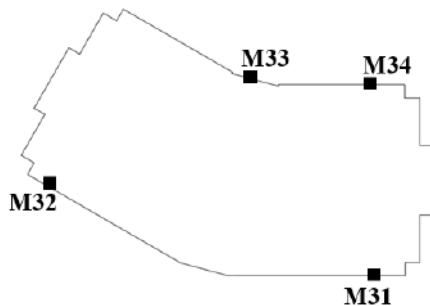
План розташування марок в рівні цокольного поверху 16-поверхового будинку
